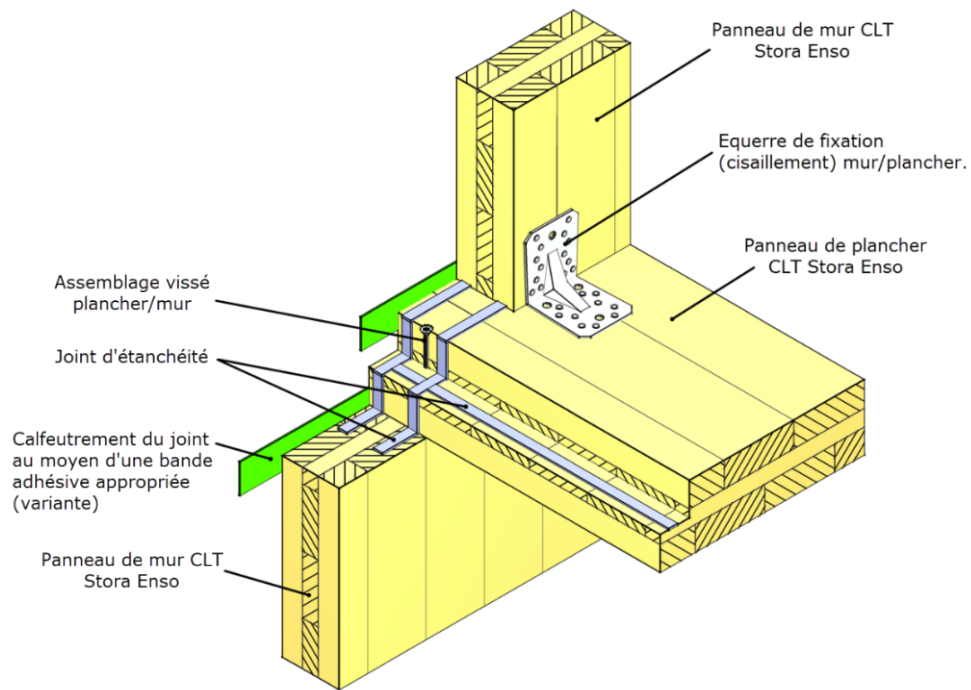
Exemples de liaison plancher – mur extérieur en panneaux Stora Enso CLT.
